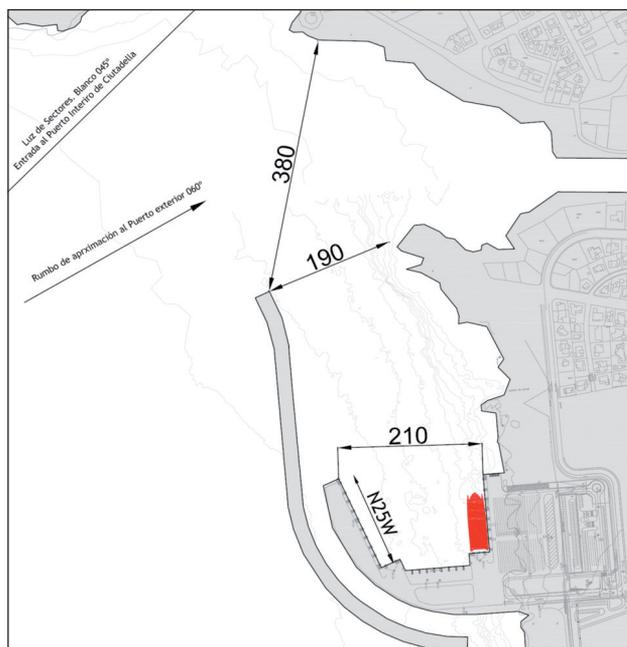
Planta Definitiva del Puerto Exterior de Ciutadella.
